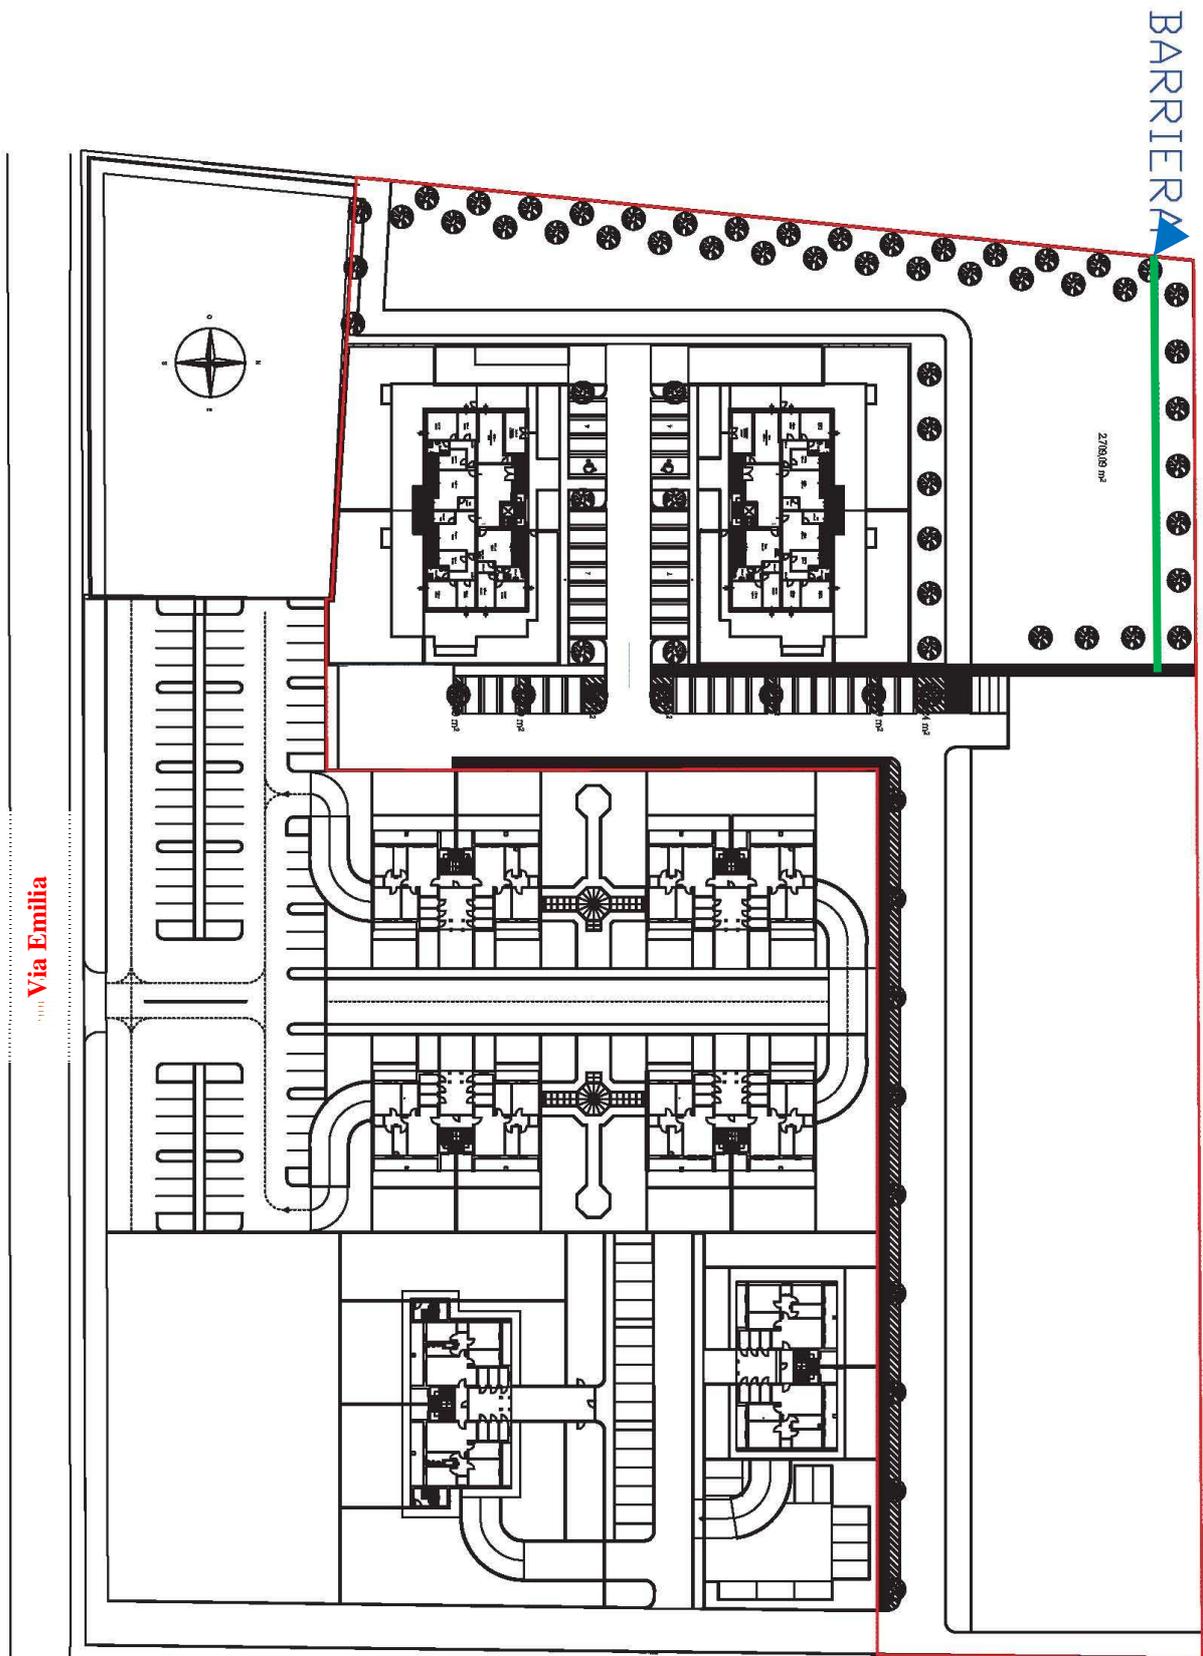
Planimetria nuovi edifici PUA e localizzazione barriera acustica.
